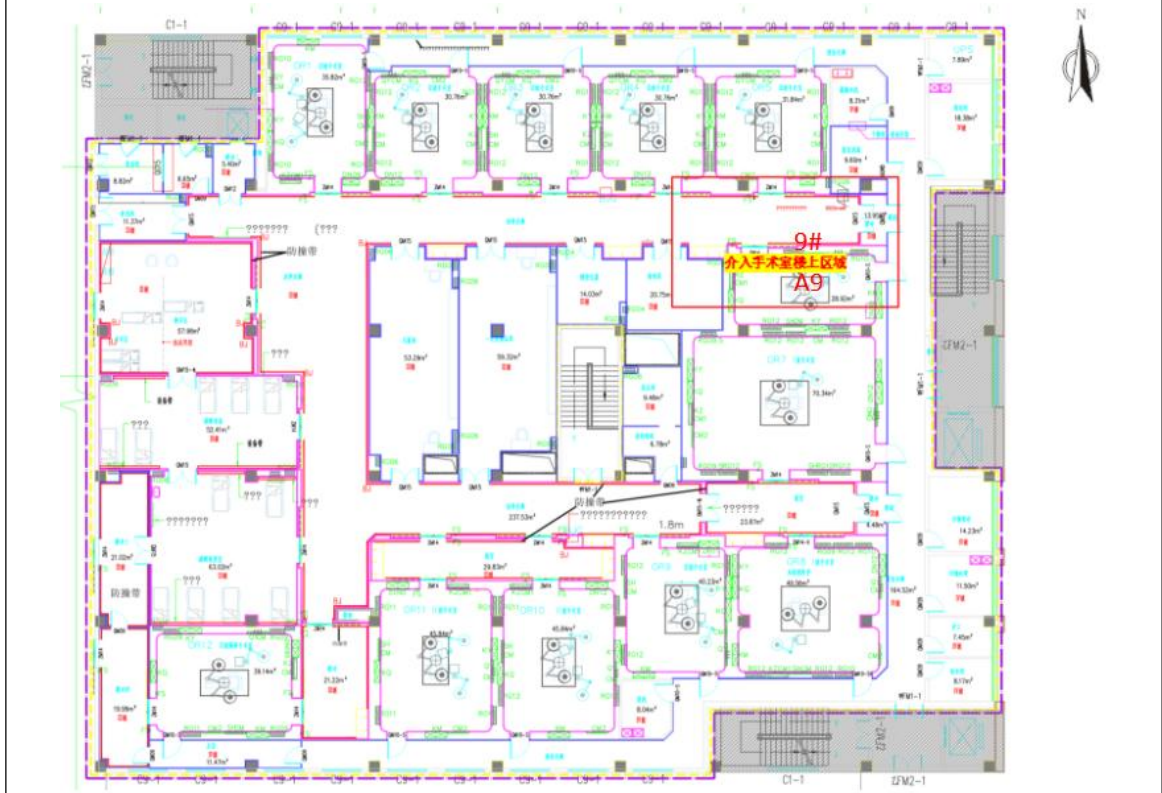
医技楼 5 层平面位置布点示意图（介入手术室楼上）
